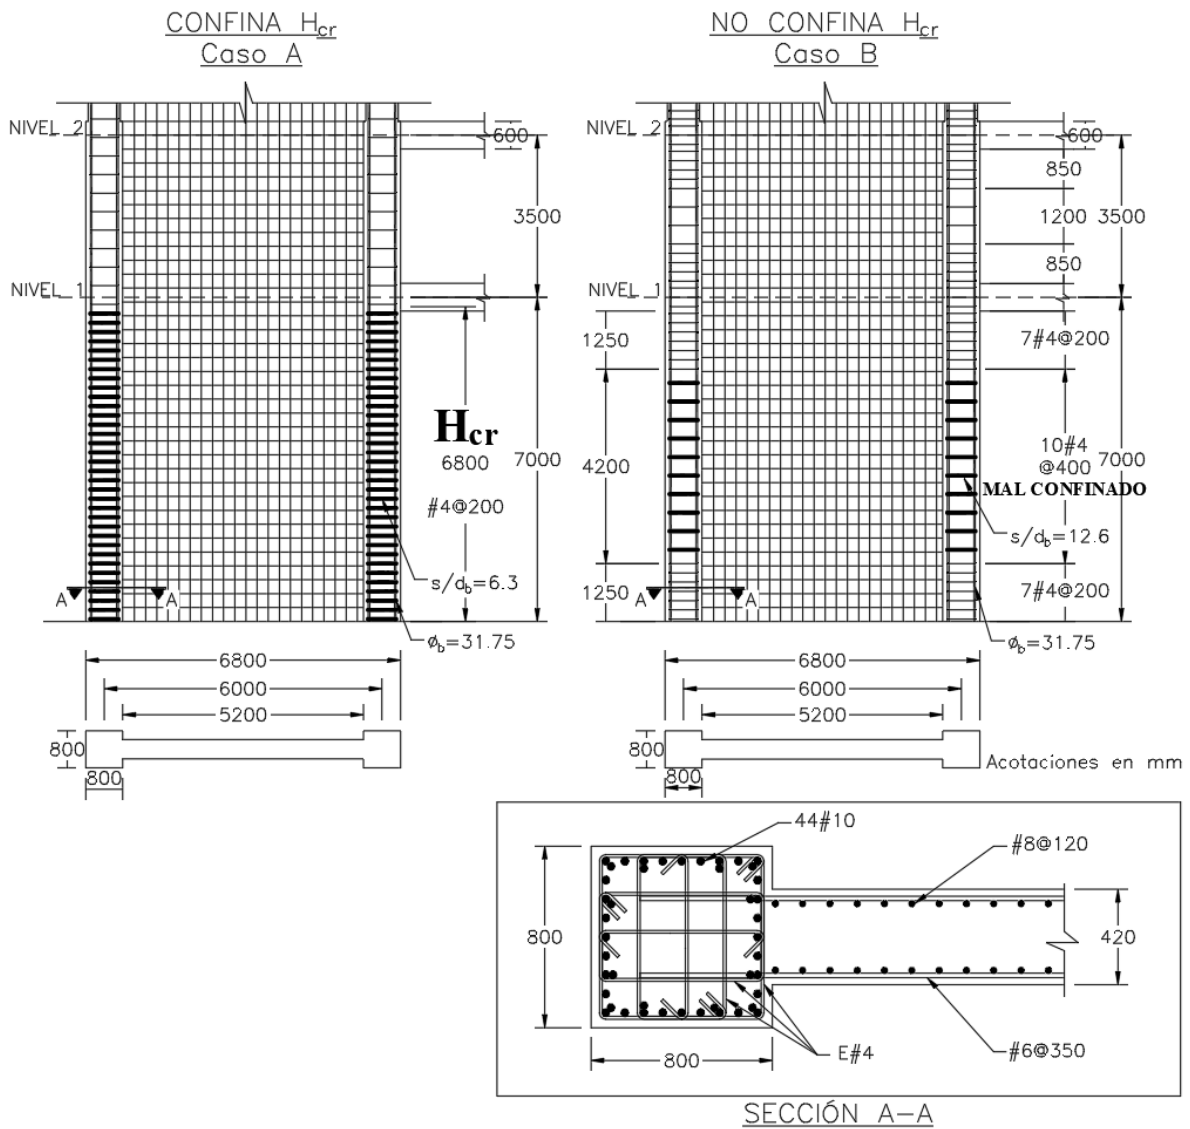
Refuerzo de la sección crítica de los muros para los casos A y B en dirección Y
